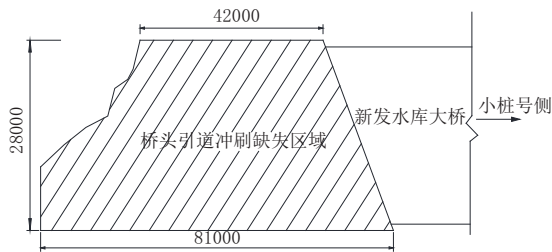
桥头引道冲毁区域平面示意图(单位:mm)
